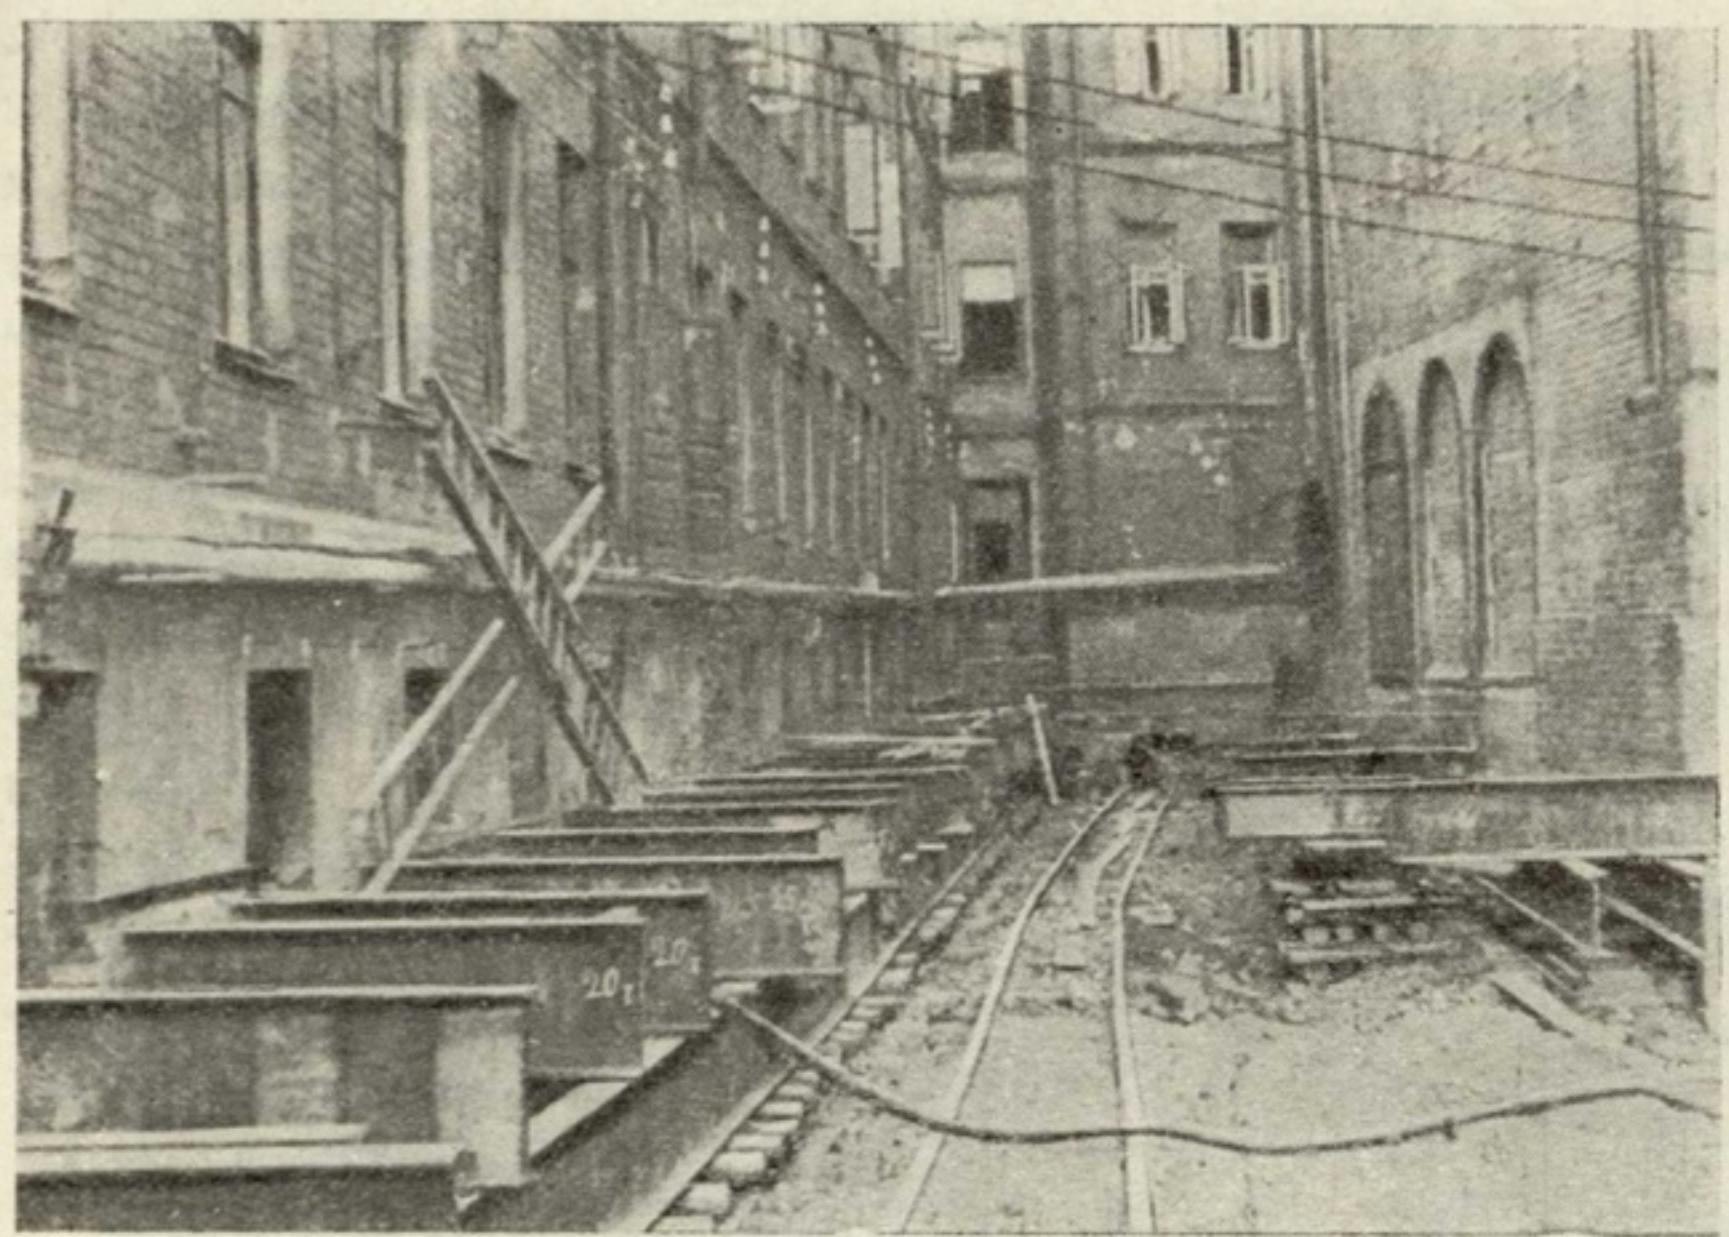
Поперечники под продольной стеной, передающие нагрузку на ходовые балки (улица Горького, 61).
